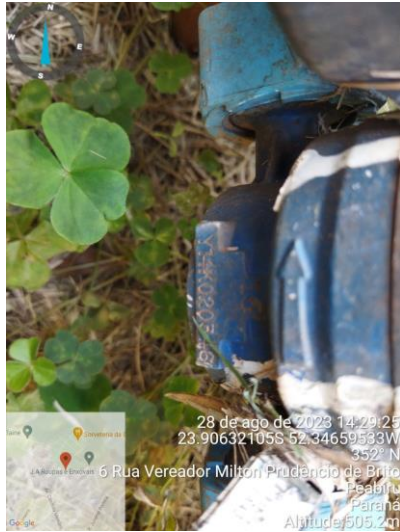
Ponto 02 pressão 40,60 m.c.a
